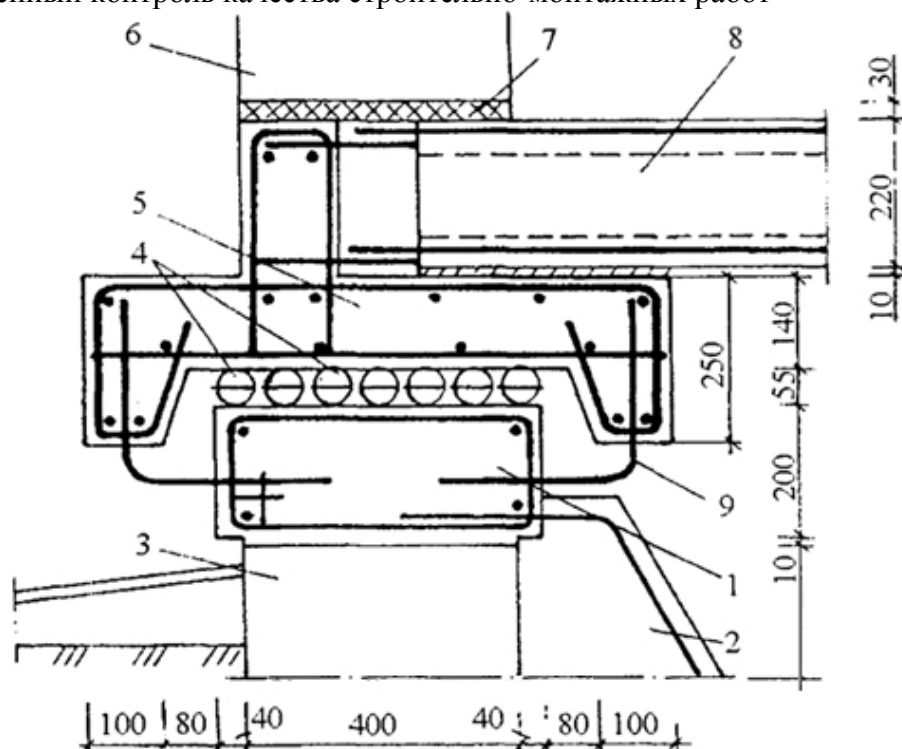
Железобетонный механизм сейсмоизоляции на сферах:
